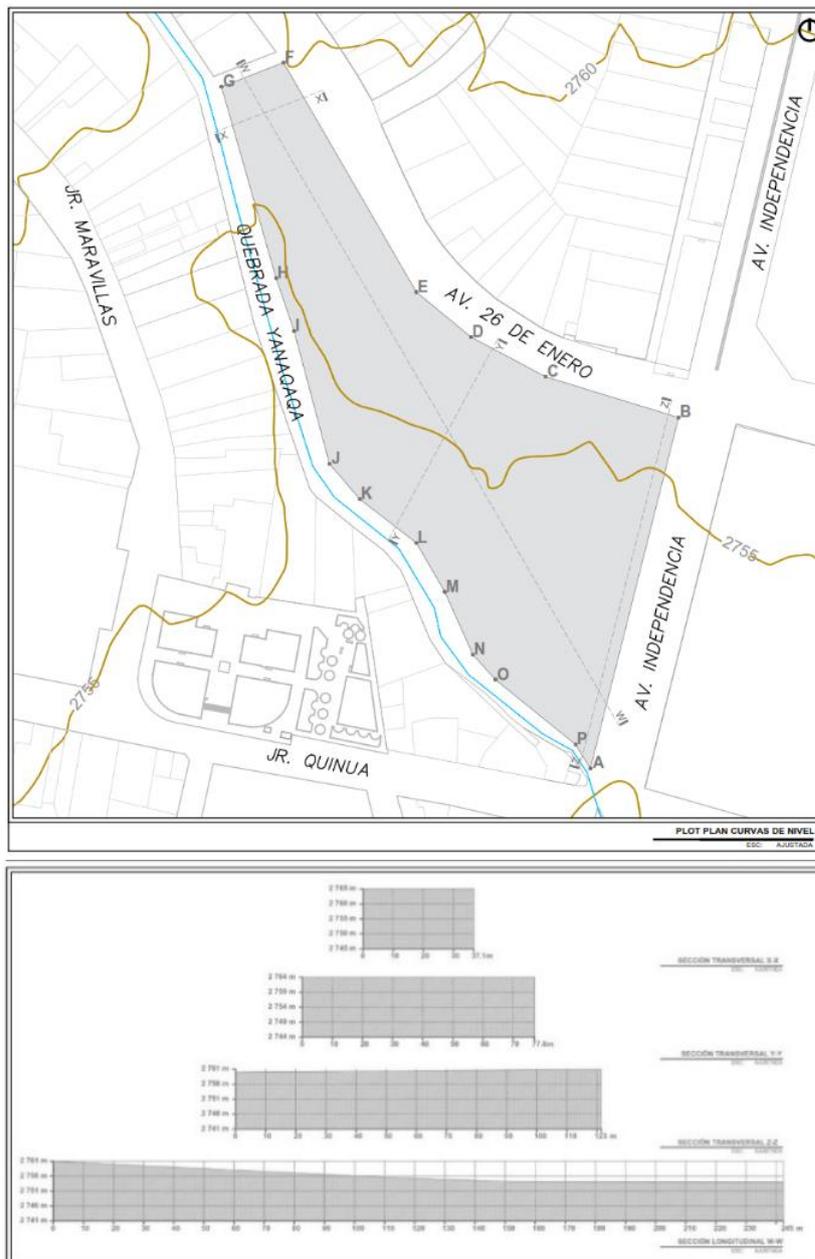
Plano de Topografía con Secciones Transversales y Longitudinales y perfil de corte.
